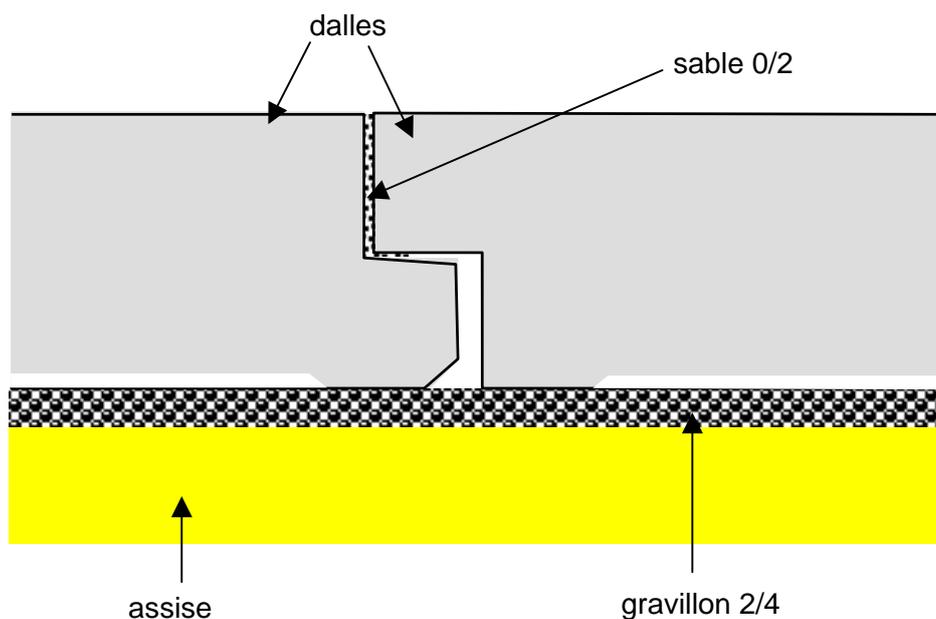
garnissage d'un joint entre dalles emboîtées.
